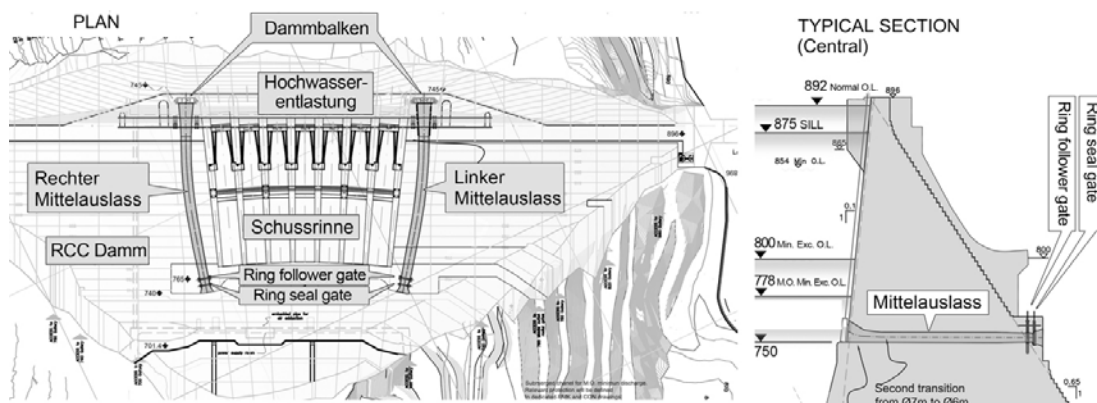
Grundriss und Querschnitt der Gibe III Mauer mit der zentralen Hochwasserentlastung und den zwei Mittelauslässen.
